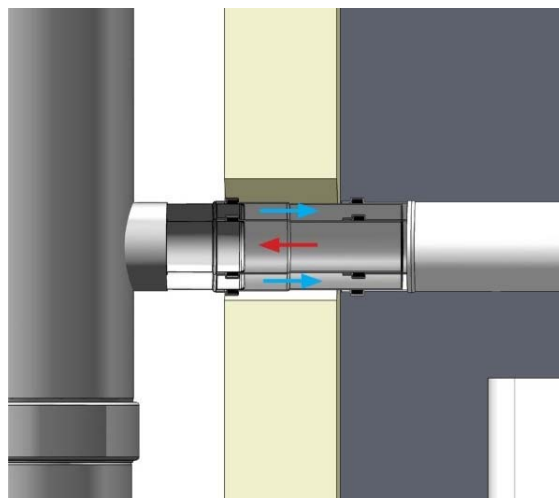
Mise en place du conduit de liaison, version DINAGAS 3CE+ à l'intérieur d'un bâtiment
